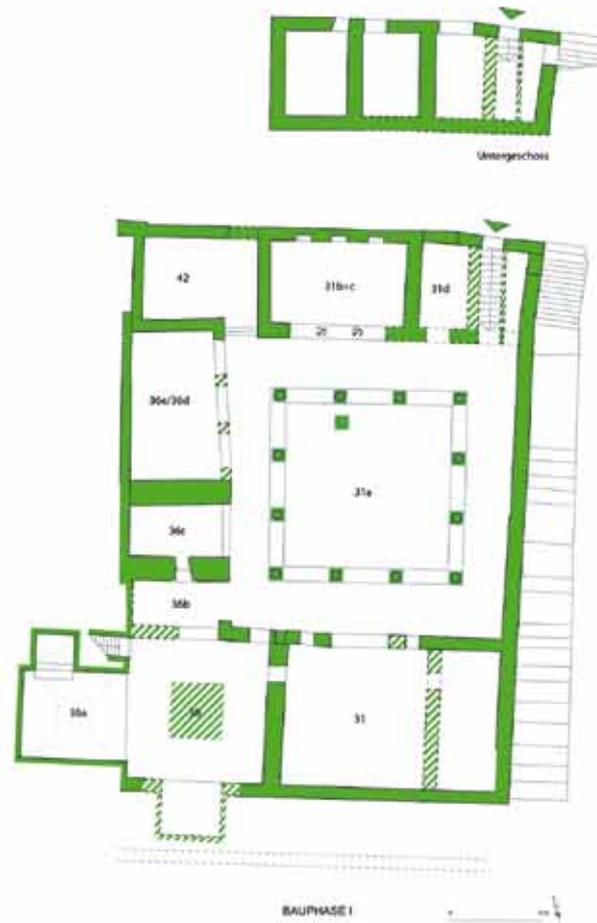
Hanghaus 2, WE 6, Grundriss Bauphase I
